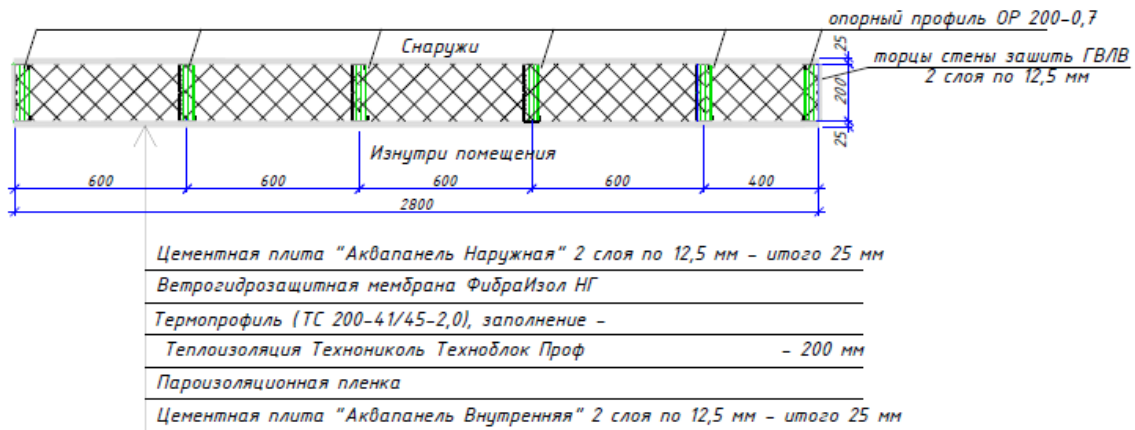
Пример сборочного чертежа с обозначением размеров, опорных элементов, «пирога» обшивки и наполнения.
